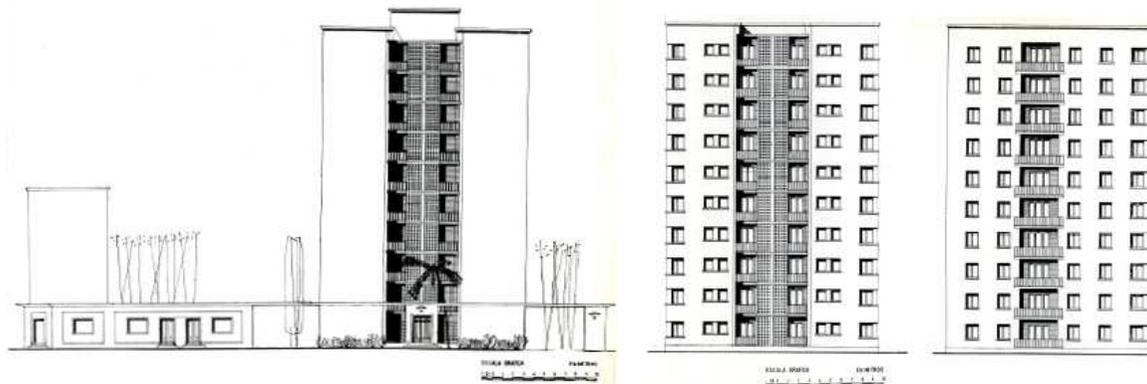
(arriba): Alzado Principal, posterior y lateral de las torres.
